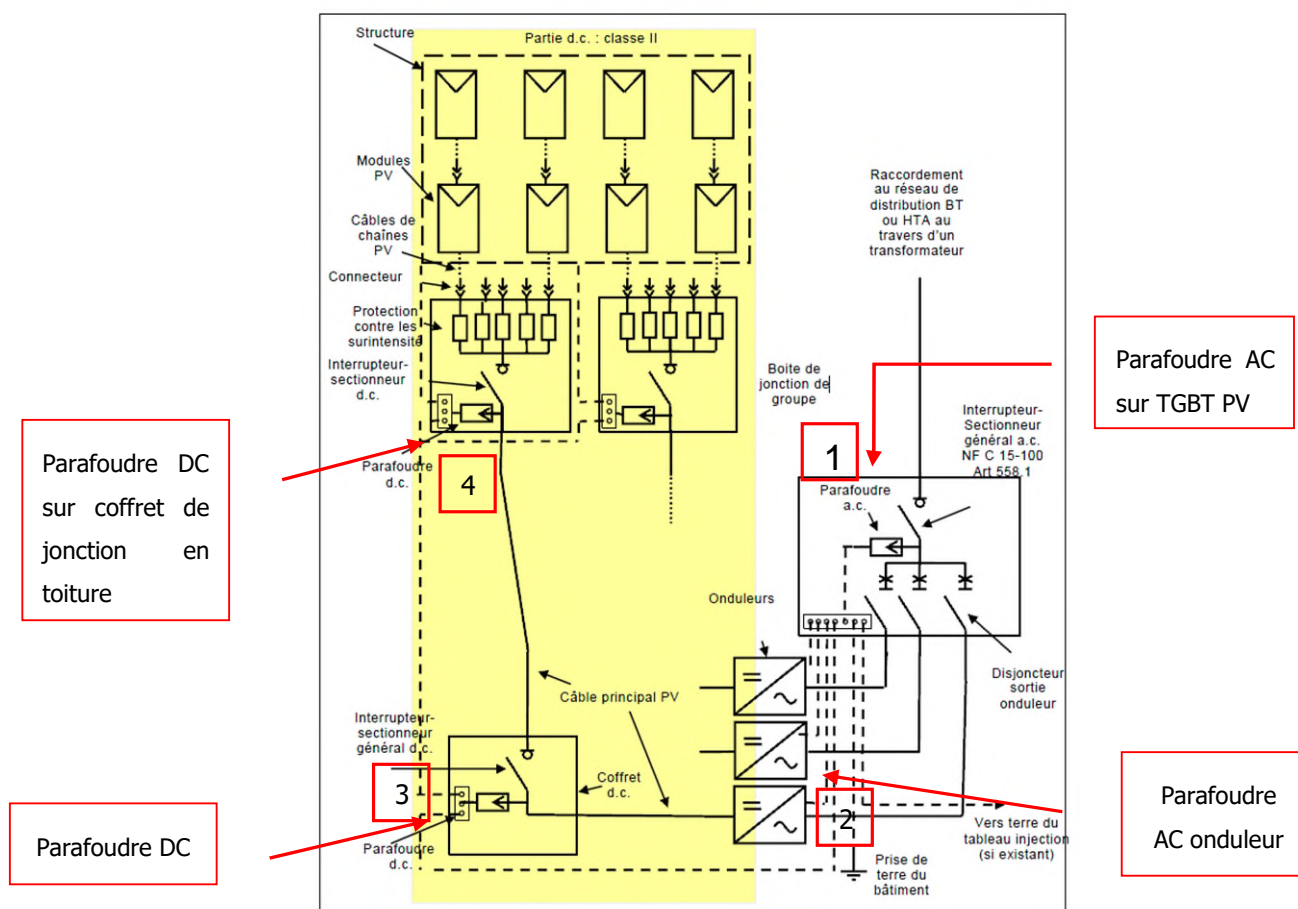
Implantation des parafoudres sur l'installation PV. (UTE 15-712)
